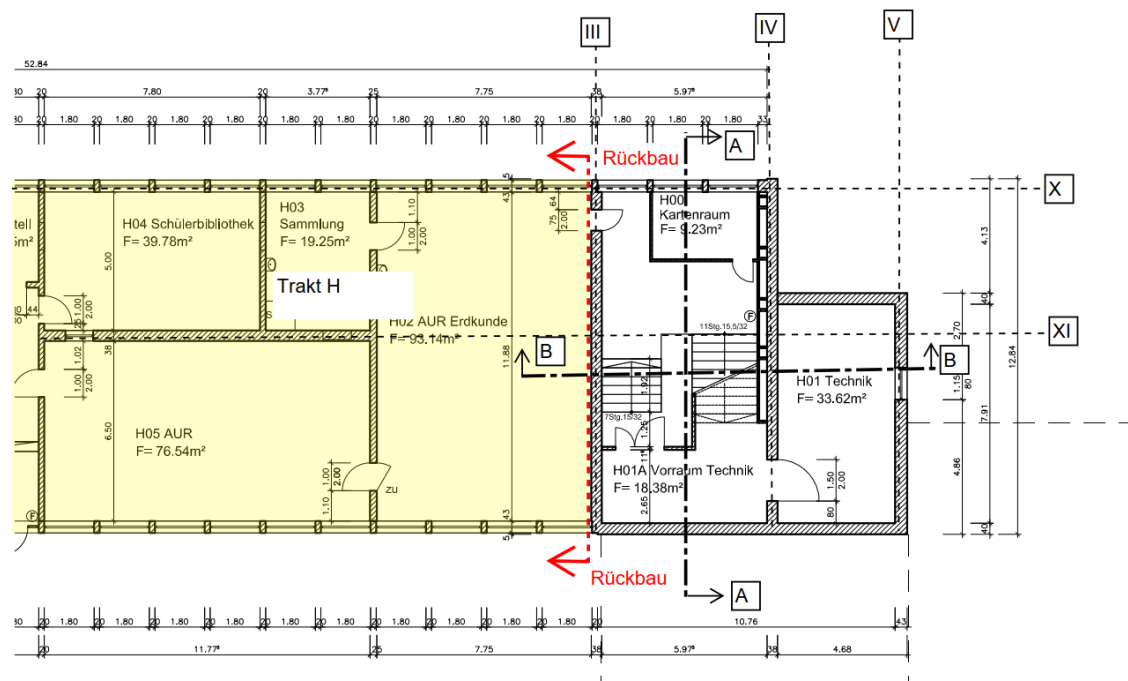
Abbruchgrenze vom Trakt H zum Trakt D - Grundriss Kellergeschoss
